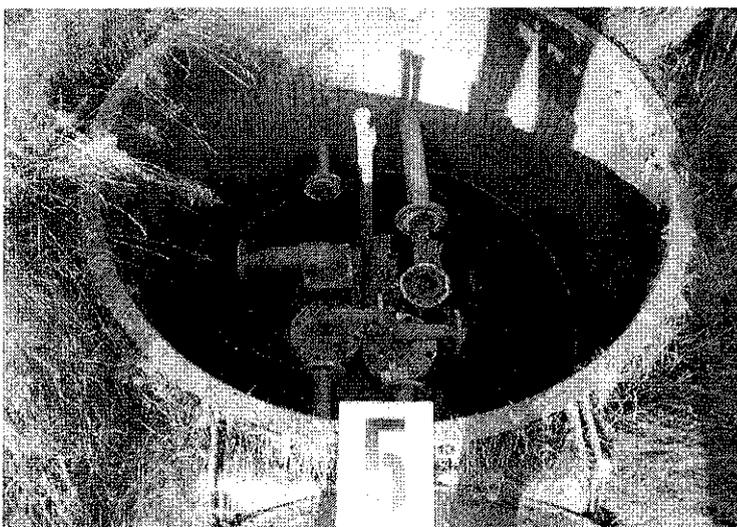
Domschacht am östlichen Ende Erdtank 2; Tankdeckel verschlossen; Leitungen verschlossen; in Domschacht steht Wasser; Aufnahme vom 13.11.01
